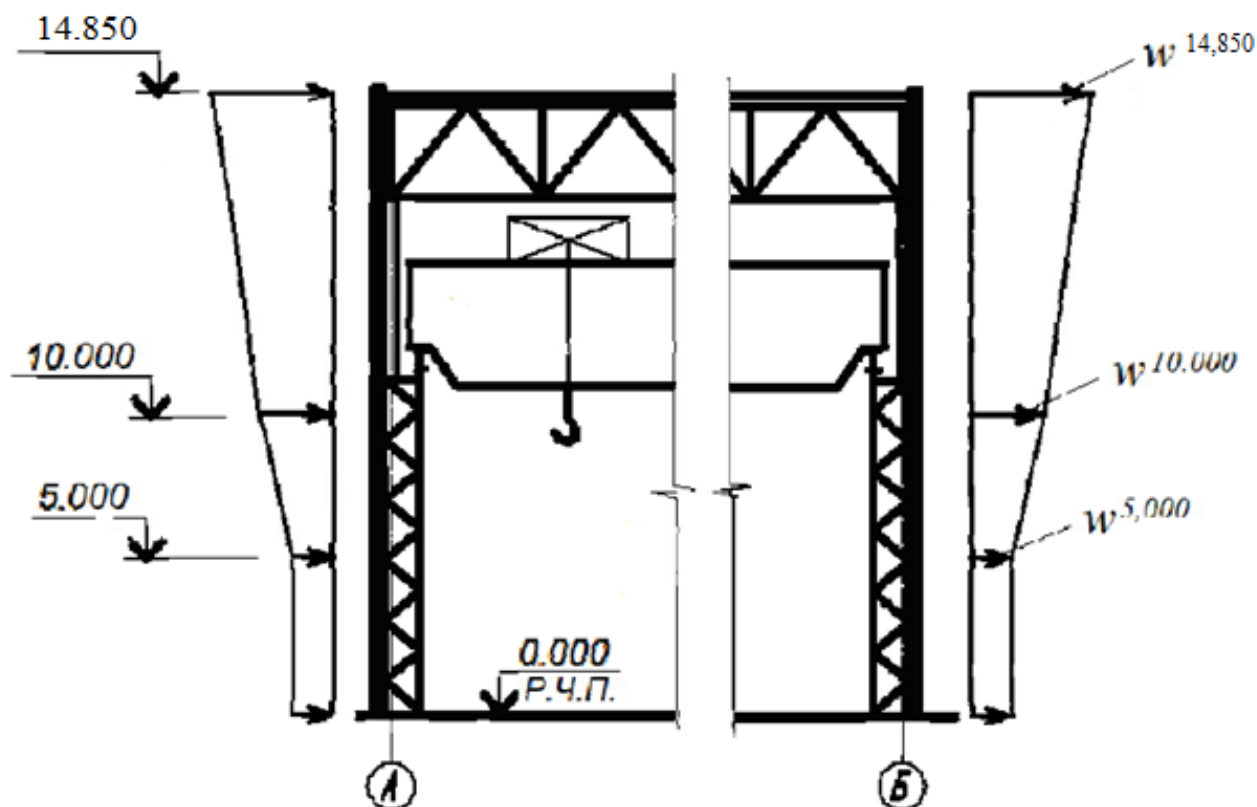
Епюра вітрового навантаження для стін будівлі
